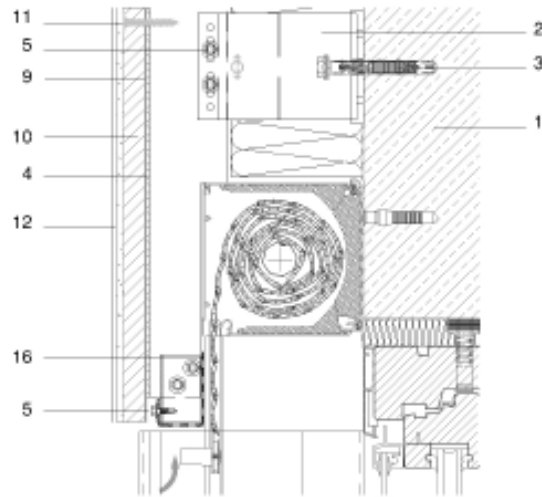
Detalhe construtivo lintel com caixa de estores [78].
